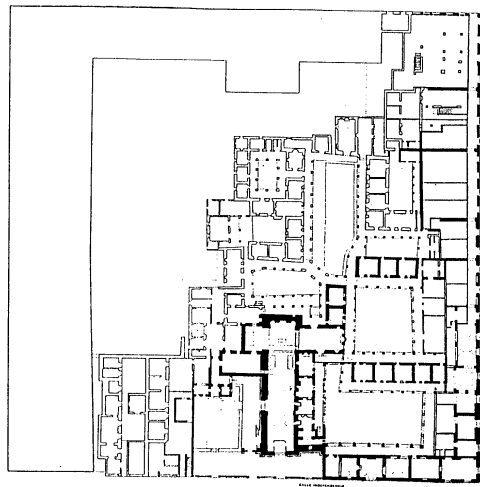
Planimetría inicial encontrada en archivo – Convento de Carmelitas Descalzas. Córdoba.
